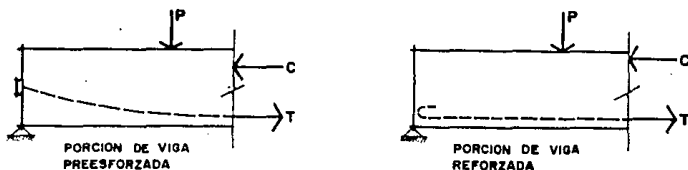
MOMENTO INTERNO RESISTENTE EN VIGAS DE CONCRETO.
